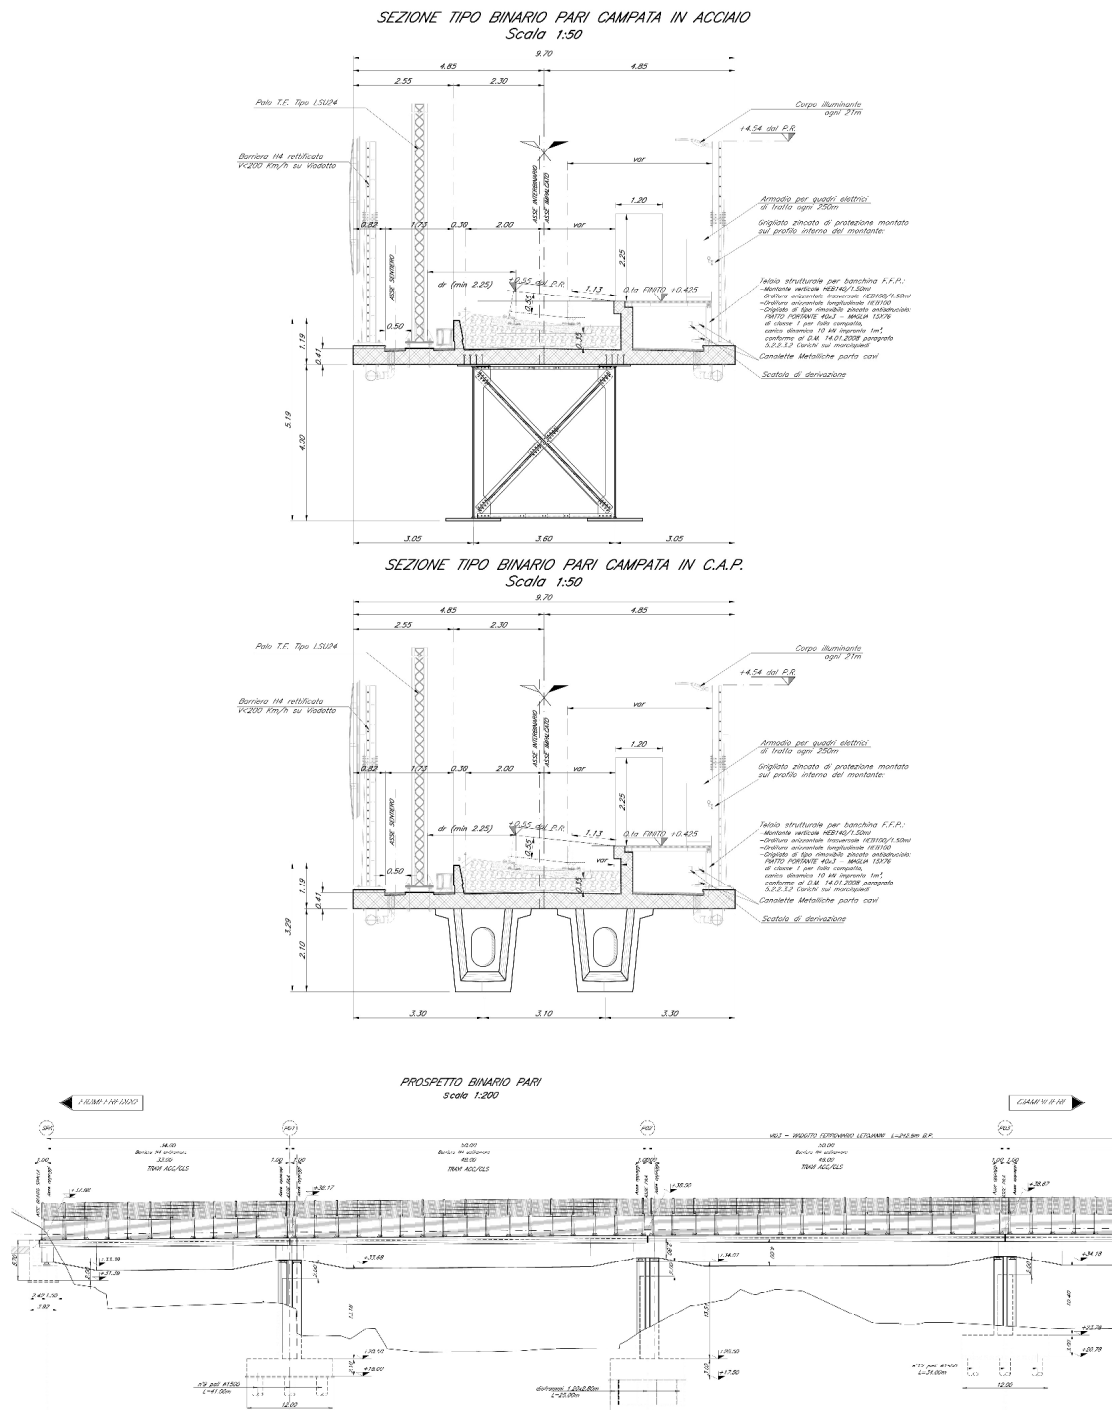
Ponte torrente Fondaco Parrino: sezioni trasversali e prospetto binario pari
